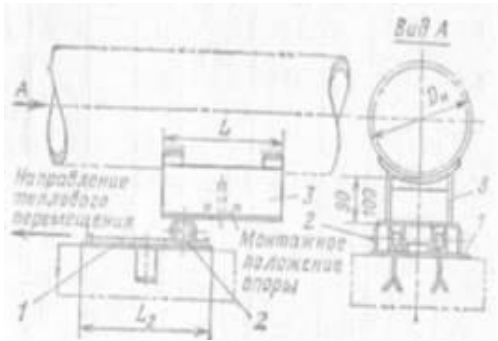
Общий вид катковой опоры: 1 - опорная плита; 2 - каток; 3 - скользящая опора
